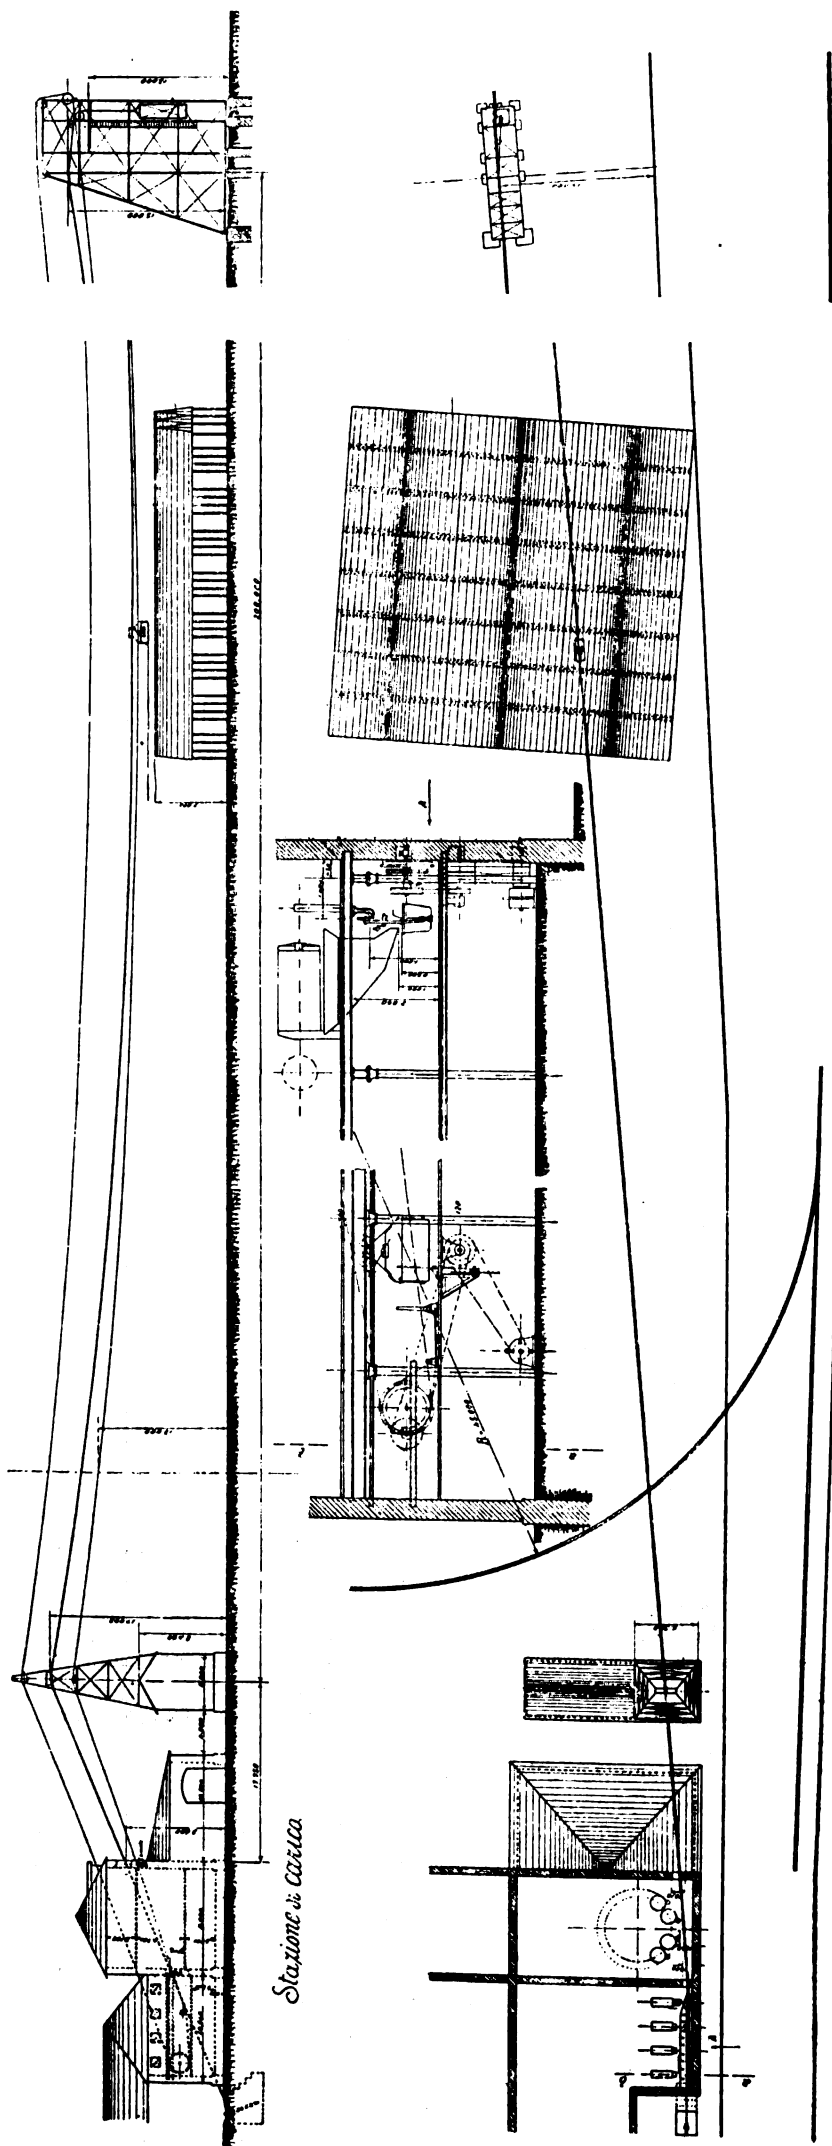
, 4, 5 e 6. — Impianto della Ditta Eclaucher & C. a St. Lou D'Esseant. - Elevazione, pianta e sezioni.
